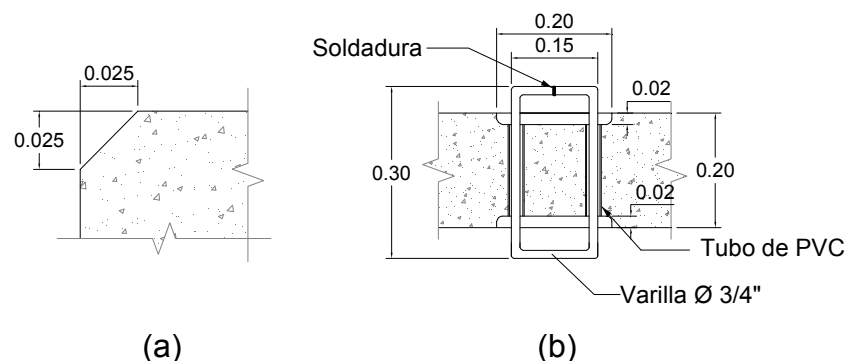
Detalles Constructivos de Placa Superior del Pozo de Inspección
